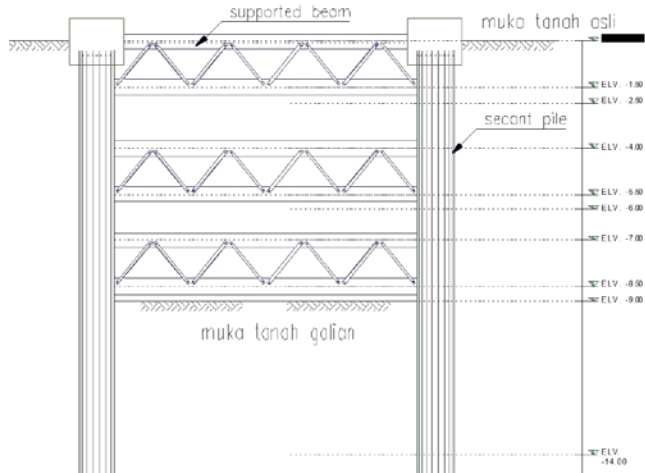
Denah *supported beam* elv. -4.00 hingga -5.50
